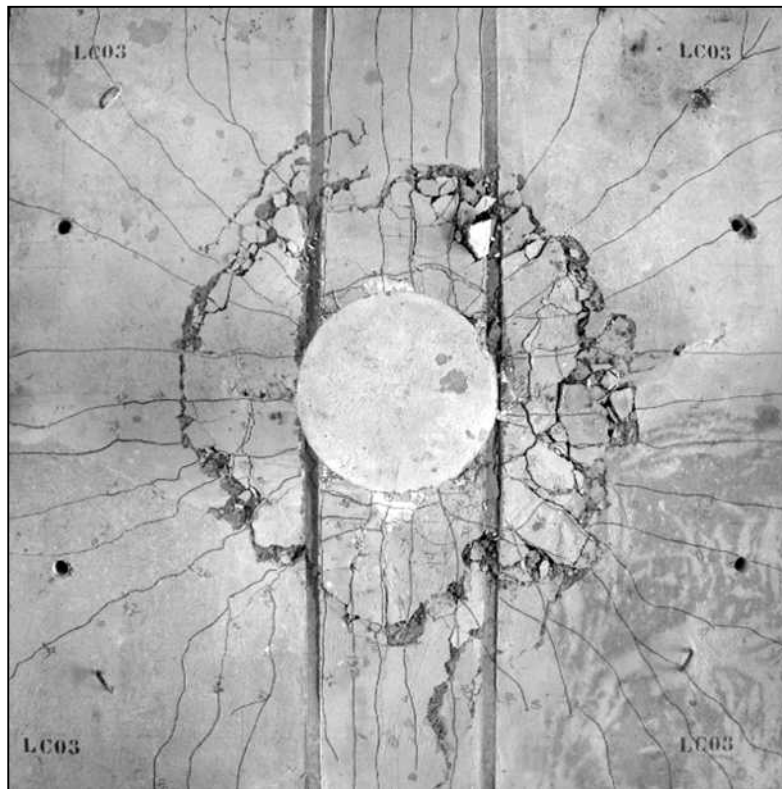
Mapa de fissuração da laje LC03
